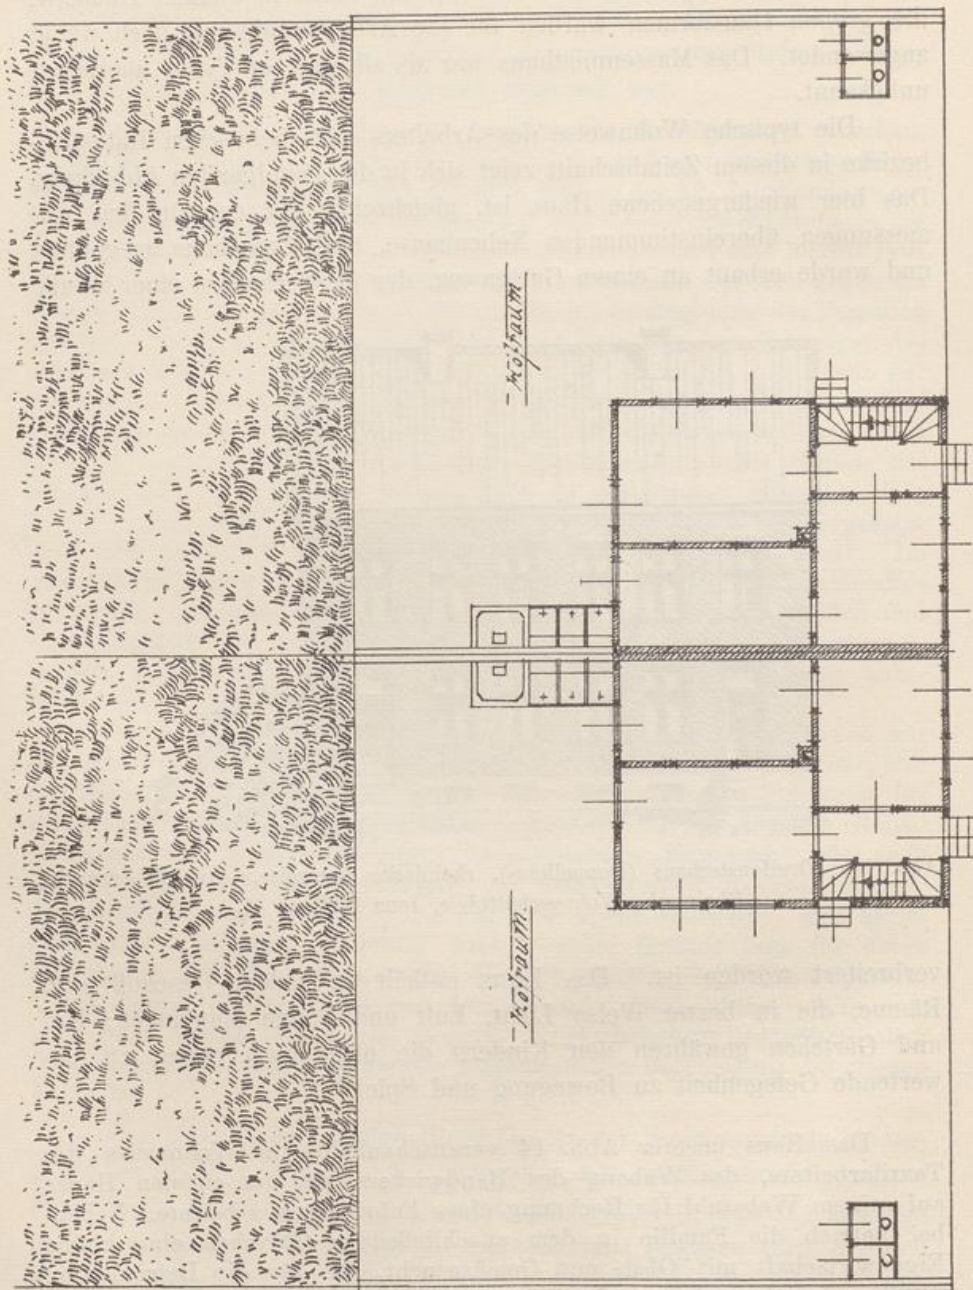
Grundriß, Erdgeschoß zu Abb. 14.
